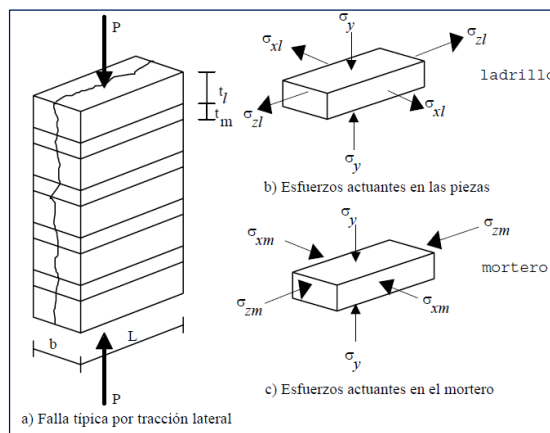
Mecánica típica de falla de la mampostería a la compresión. Adaptado de Tena y Miranda, 2003.
